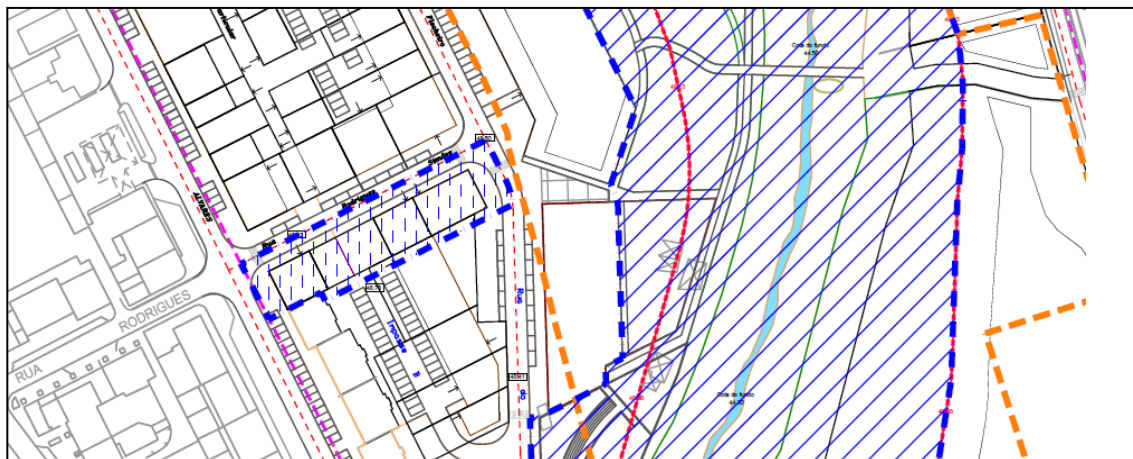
Pormenor do extrato da Planta de Implantação, 1:2000, julho de 2021, relativo à Área 2
